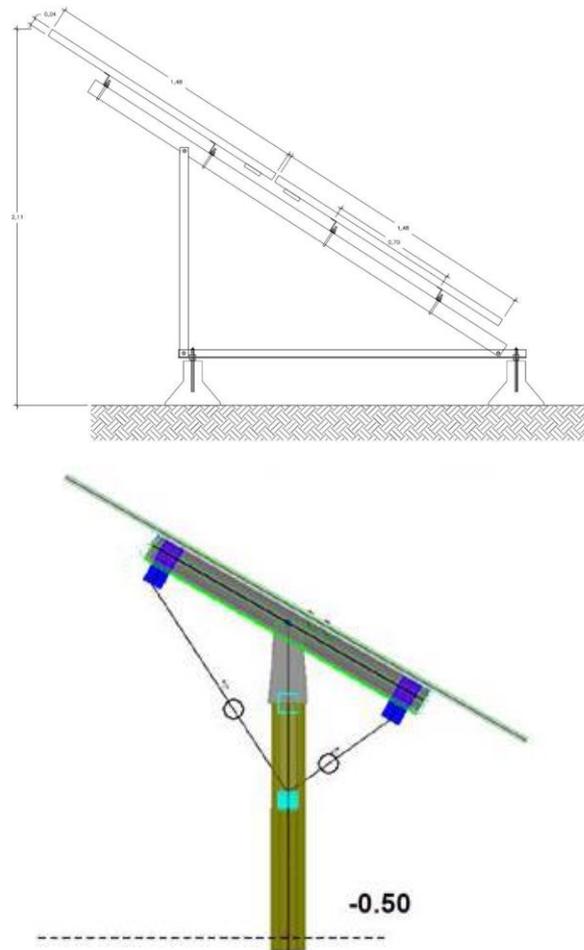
Estruturas de suporte para painéis fotovoltaicos (fixas ou seguidor 1 eixo).
